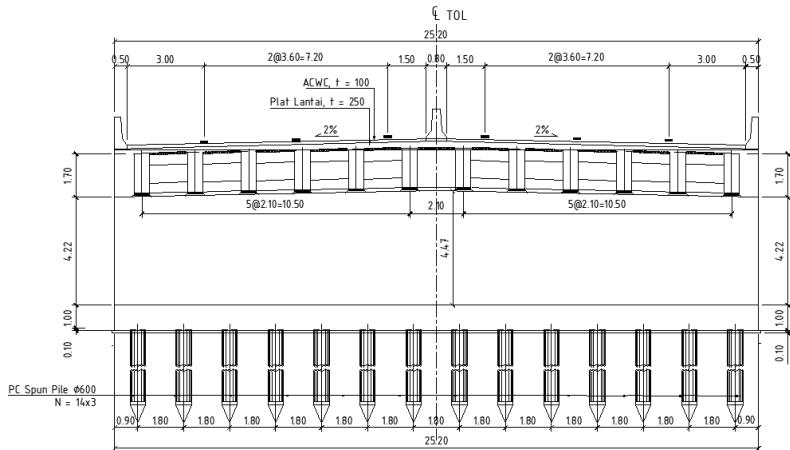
7 Desain Eksisting Memanjang Jembatan
